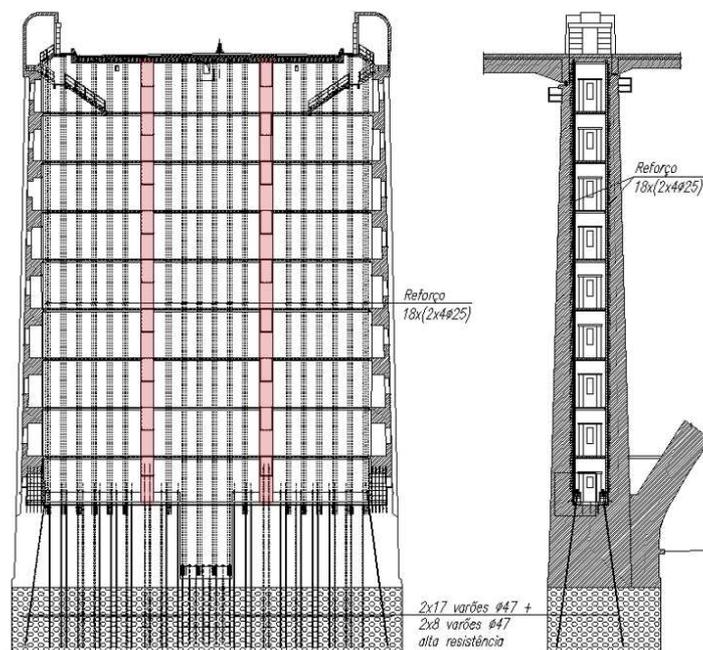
Corte longitudinal e transversal das pilastras ilustrando a solução de reforço.
